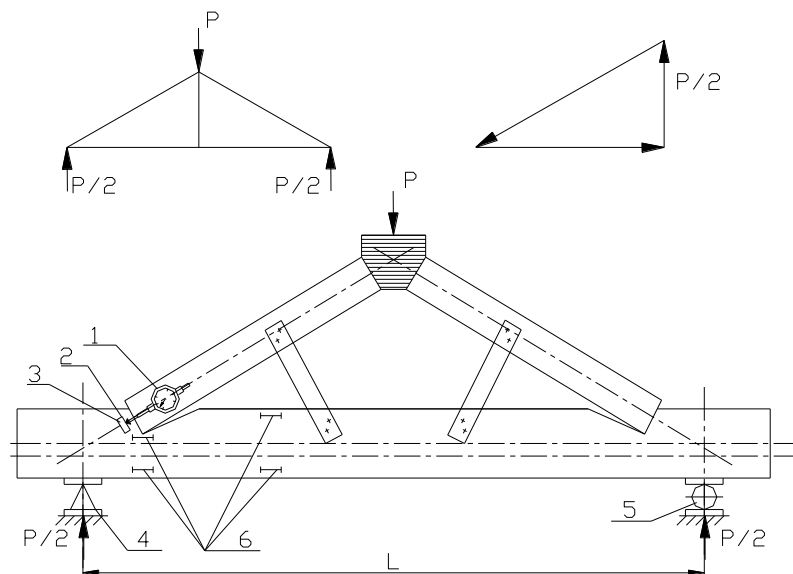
Схема загрузки образца и расстановки приборов:
